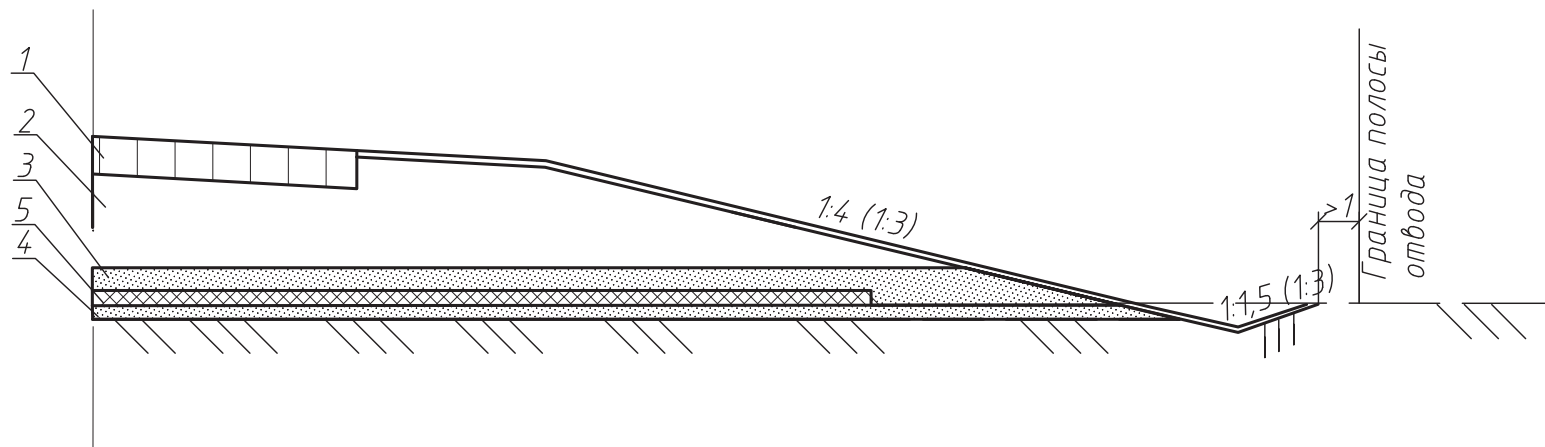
Тип 2. Насыпь высотой до 3(2)м с боковыми резервами и кюветами
